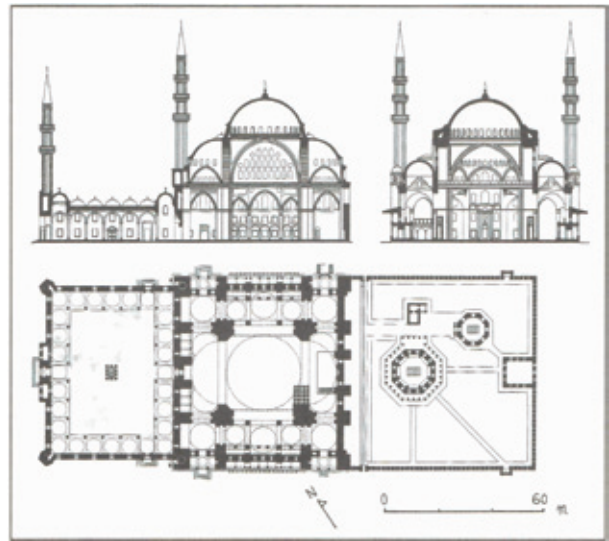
スレイマニエ・ジャーミーの平面図および断面図（同図版2と同じ引用）
